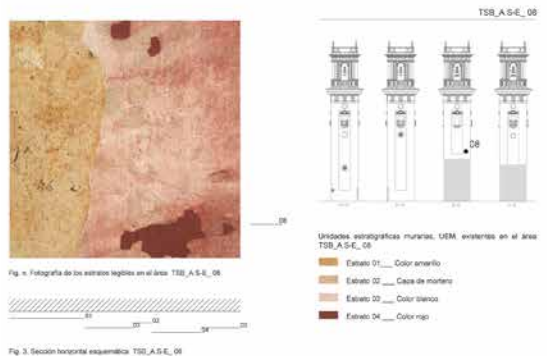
Sección horizontal esquemática TSB\_A\_S-E\_08
